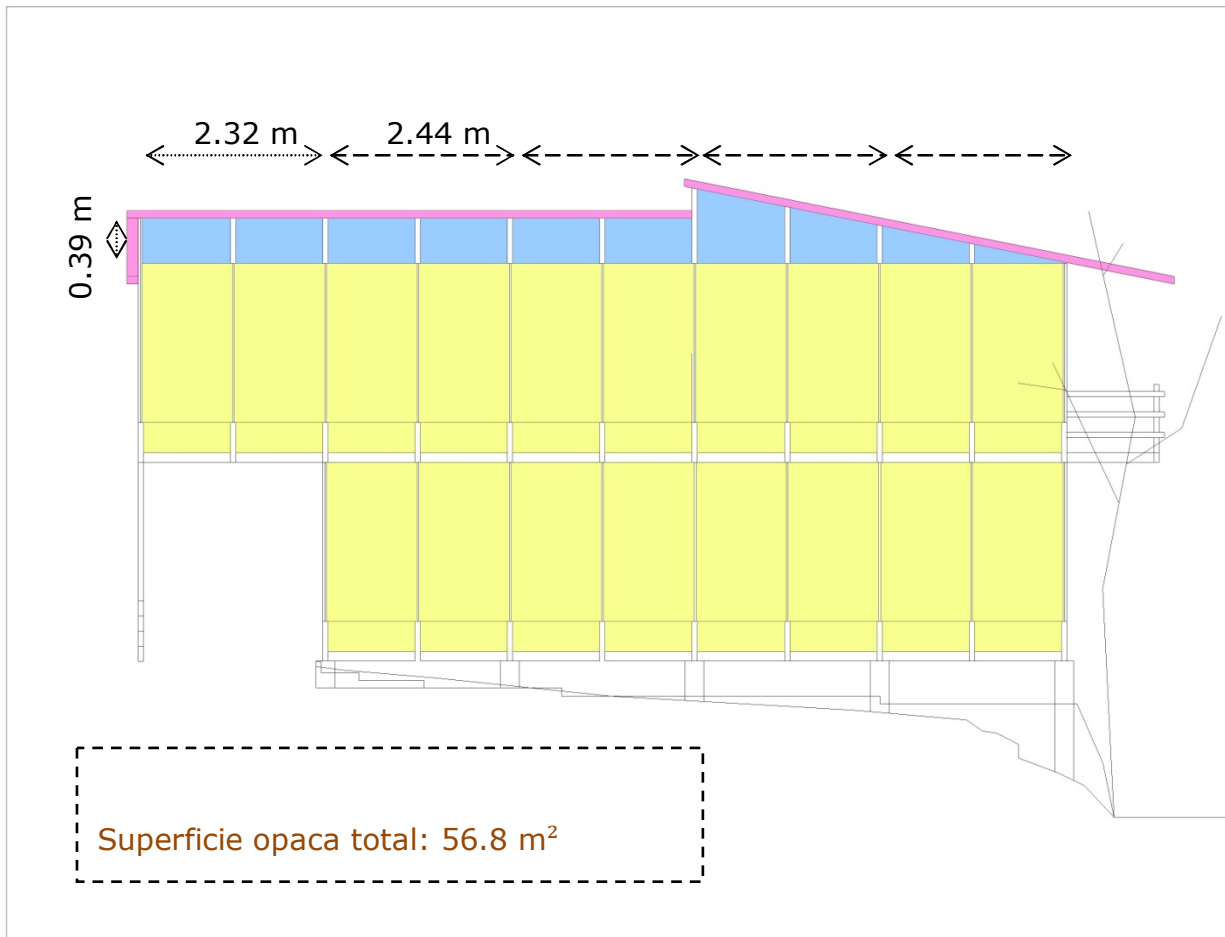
c-17 - Corte transversal de la pared sud de la planta alta
